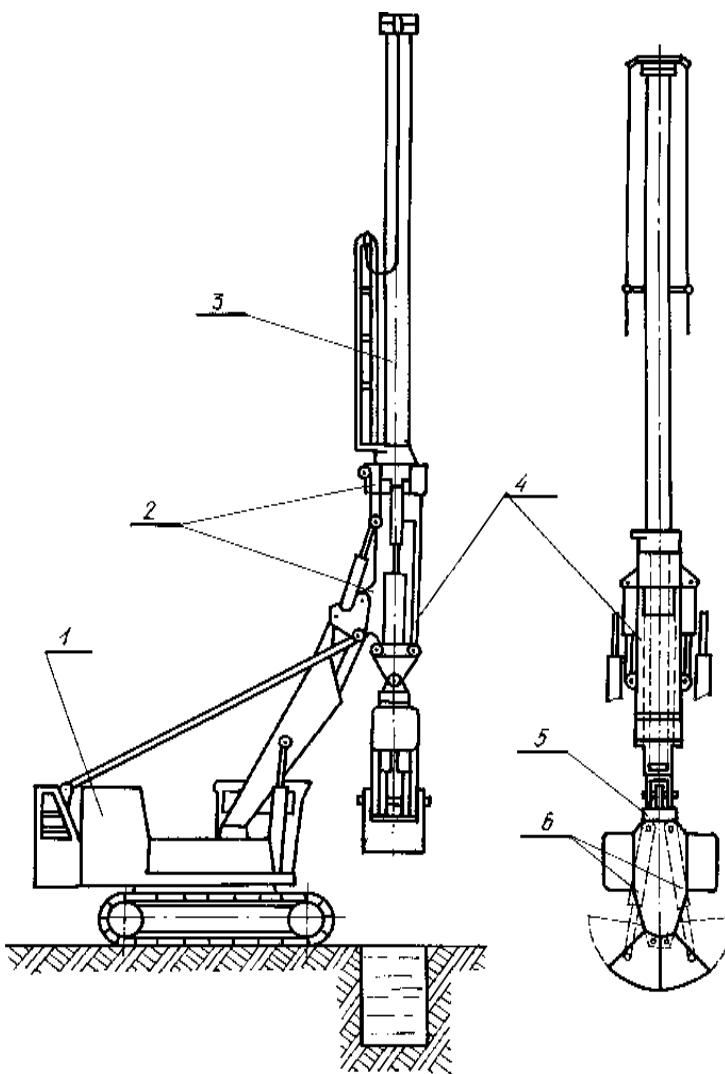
Экскаватор ЭО-5122 с грейферным оборудованием на телескопической напорной штанге: 1 — базовая машина; 2 — блок крепления штанги; 3 — штанга телескопическая; 4 — механизм перемещения штанги; 5 — грейфер; 6 — гидроцилиндры челюстей грейфера
